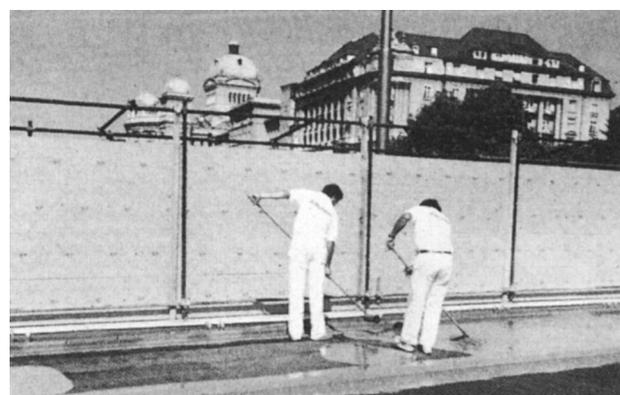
Esecuzione di una nuova impermeabilizzazione di un ponte con materiale sintetico liquido (MSL).
